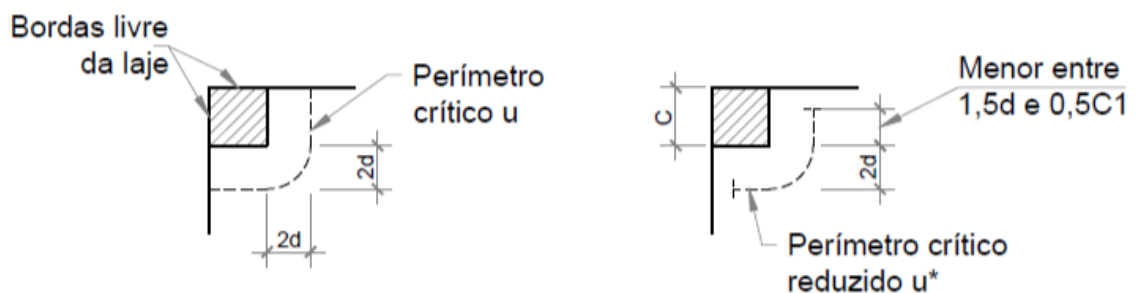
Perímetro crítico em pilares de canto (SILVA, 2017)
